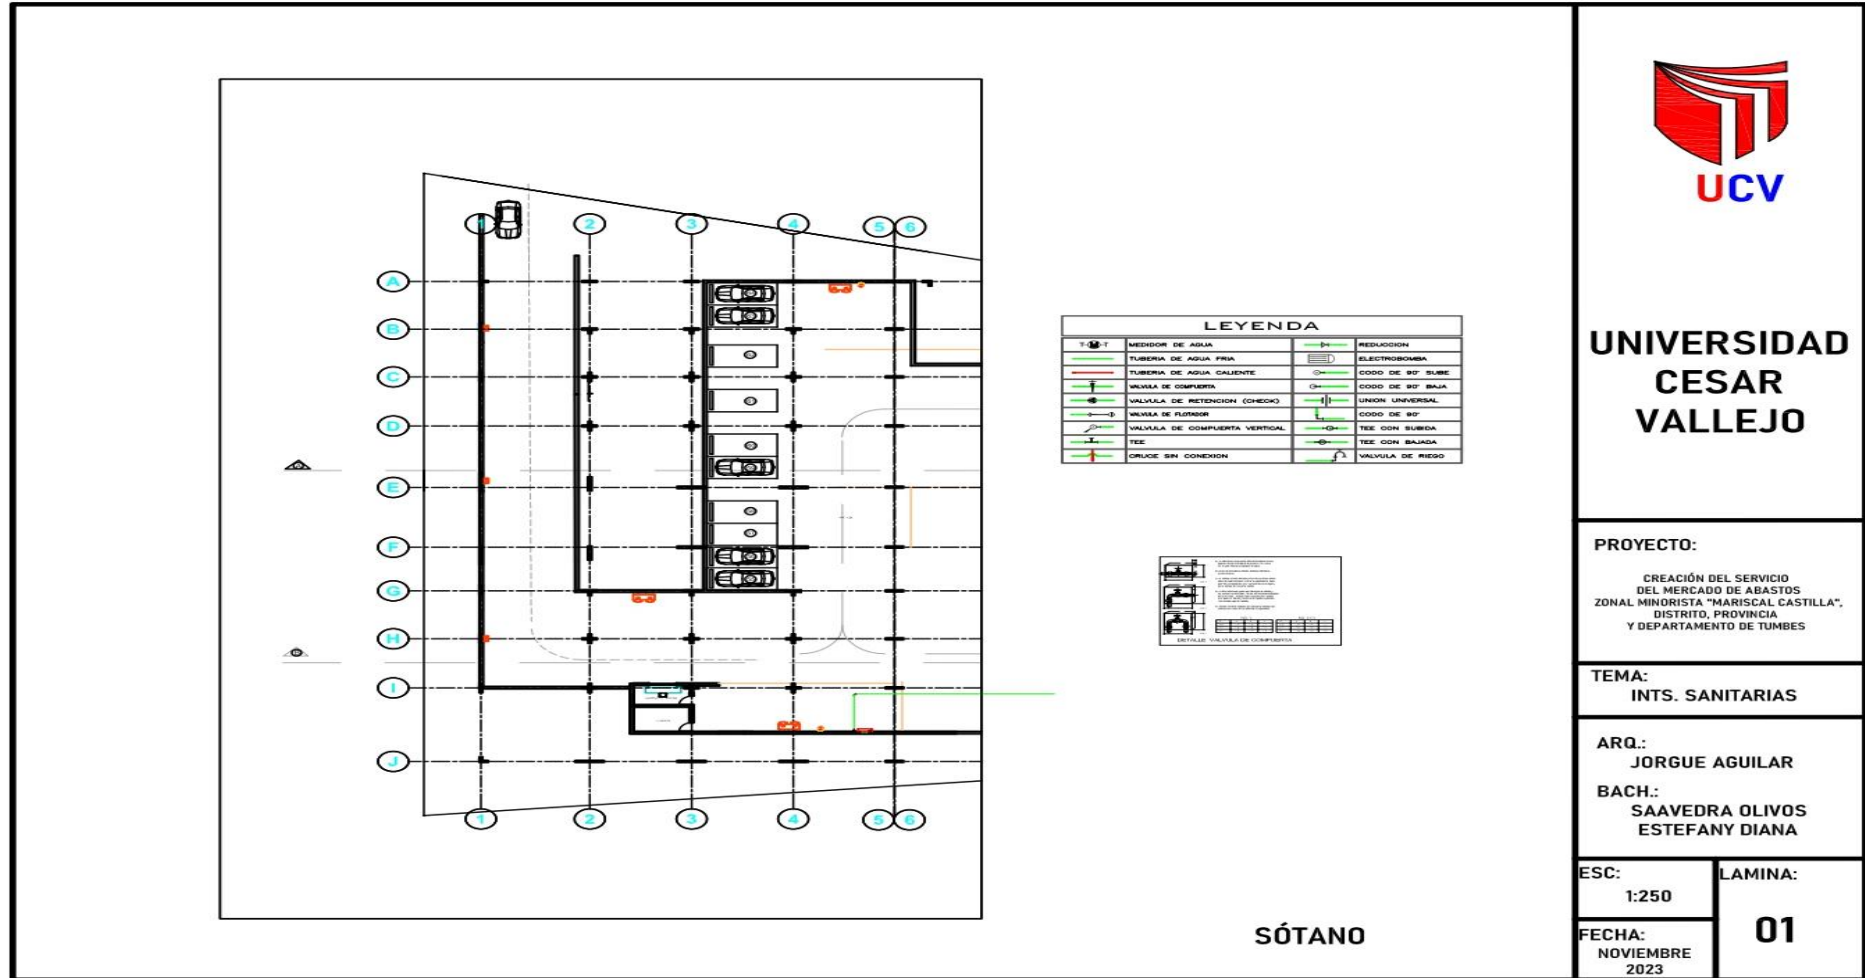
Inst. sanitarias - sótano. Fuente: Elaboración propia.
